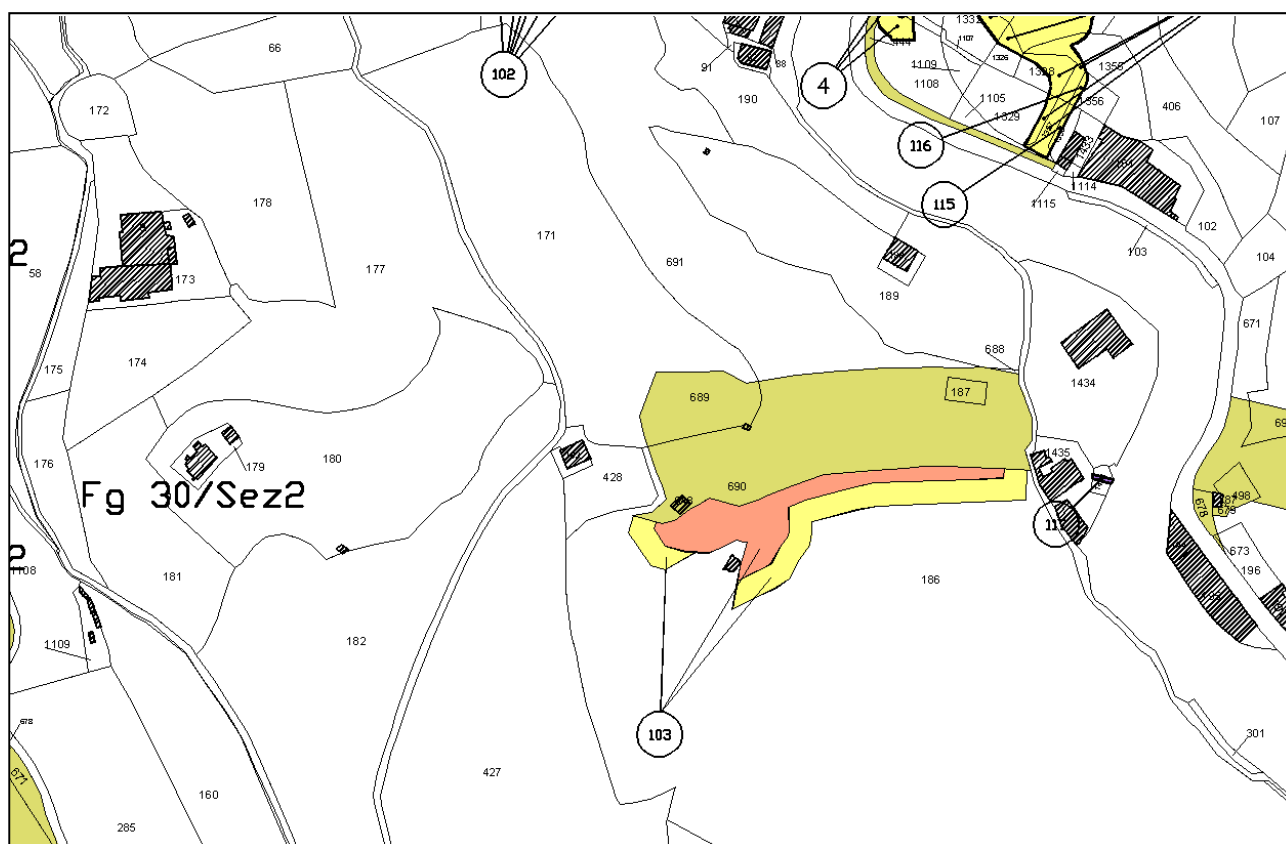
Pista di cantiere per le pile e la spalla dell'ampliamento del viadotto Leiro
